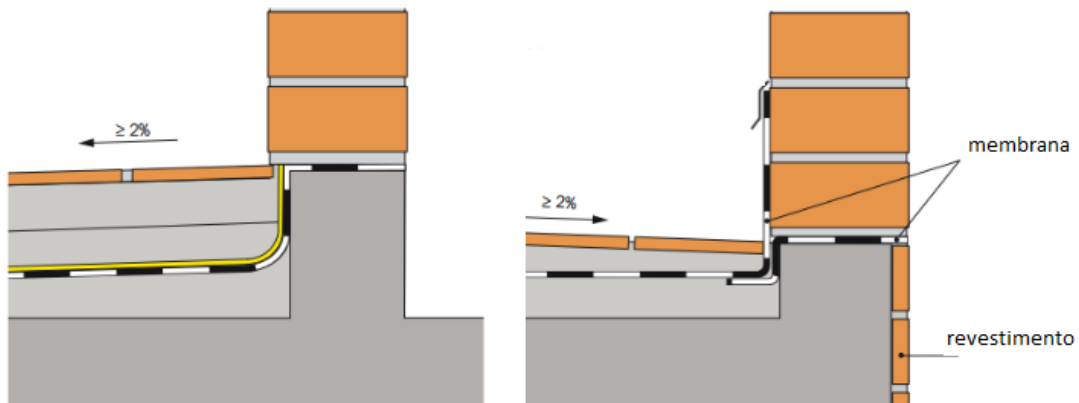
Corte esquemático da impermeabilização de uma platibanda
